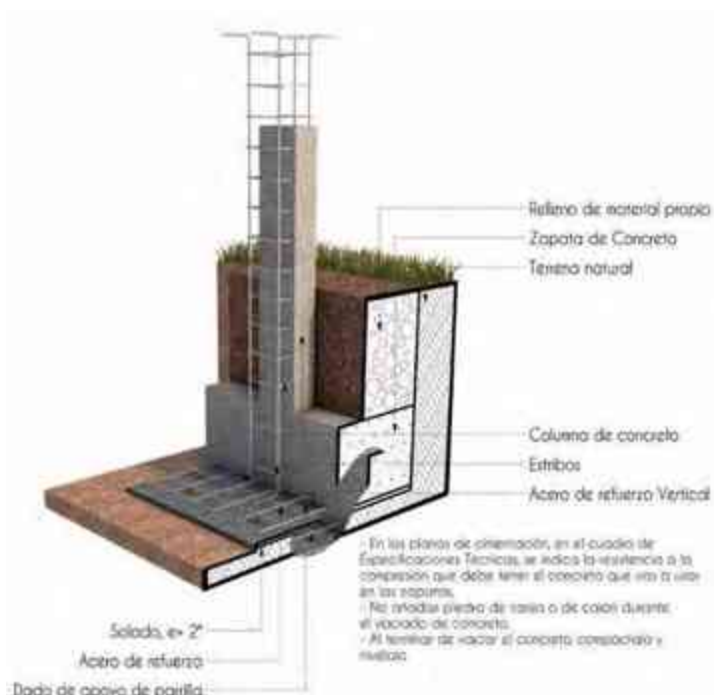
obtenida el 20 de Noviembre de 2015 construmatica.com, muestra un claro ejemplo de los detalles de una zapata aislada, edito JIHS.
